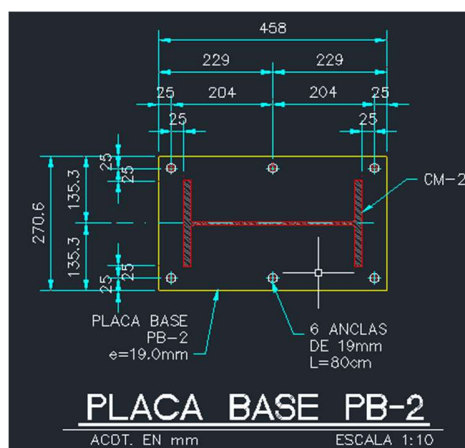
Detalle de placa base de estructura de elevador. Elaborado por el autor.
